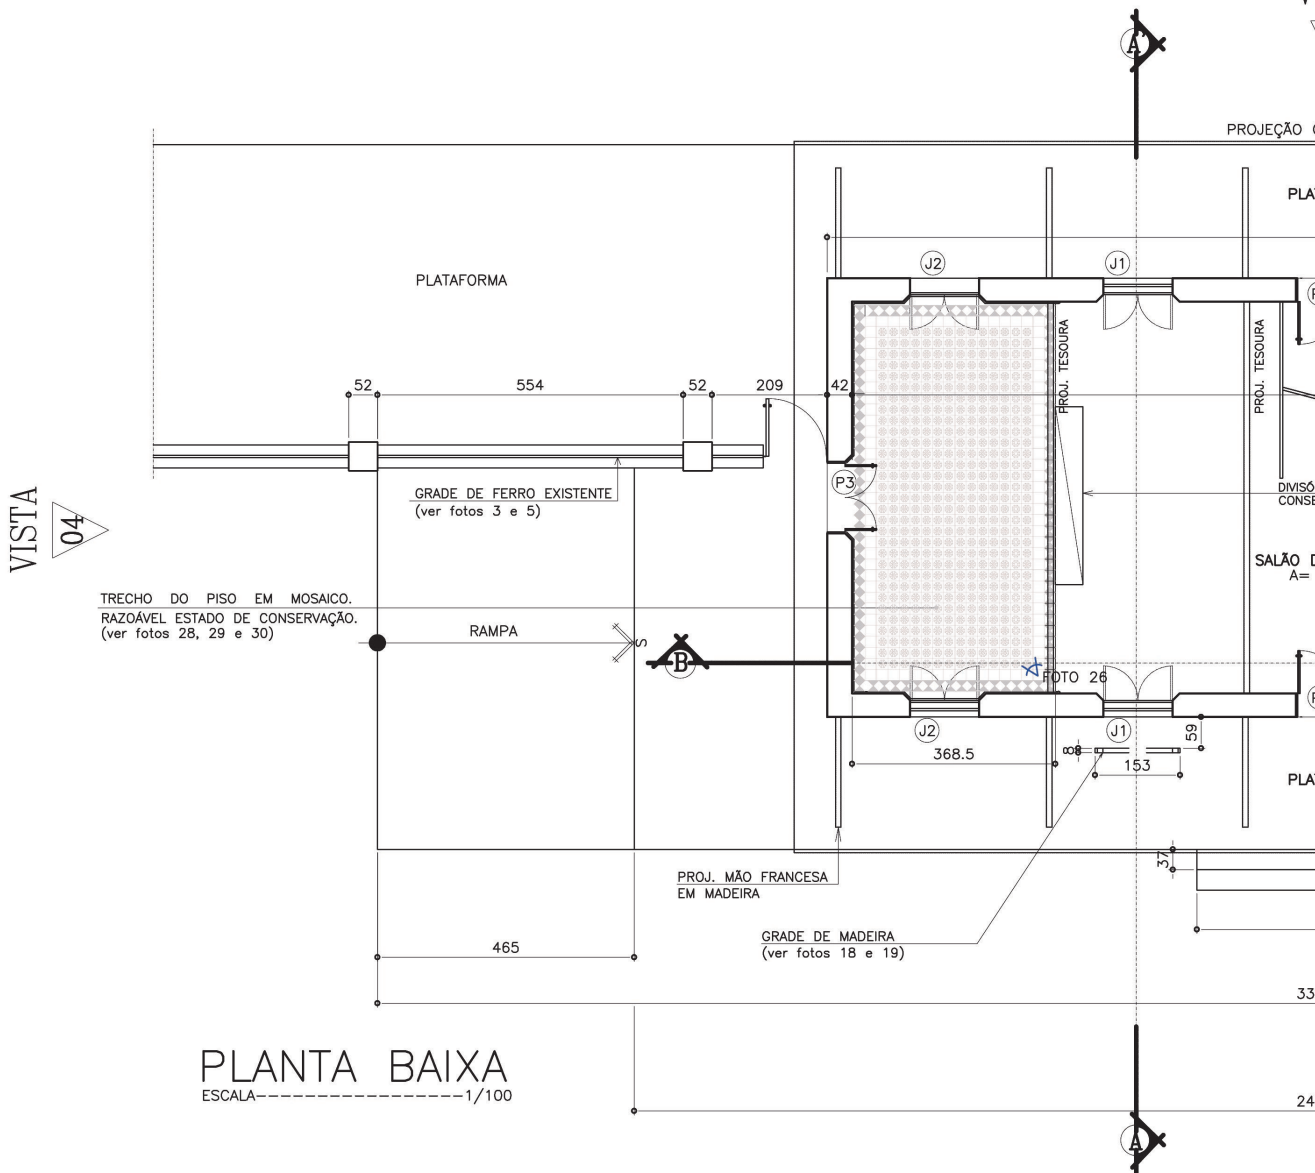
Planta Baixa do Museu do Trem do Piauí. | Fonte: IPHAN.
